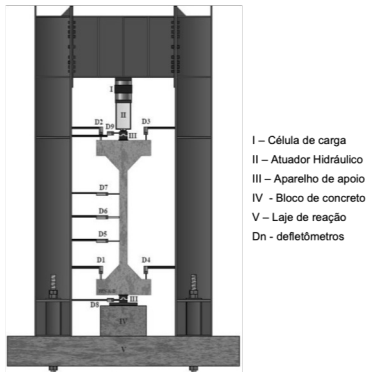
Pilar posicionado no pórtico de reação com a instrumentação
